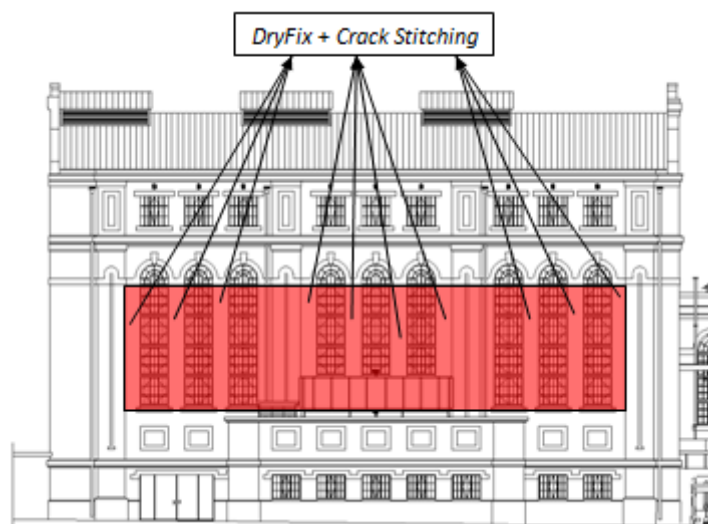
Zona de consolidação dos panos de alvenaria. Fachada Sul da BP.
